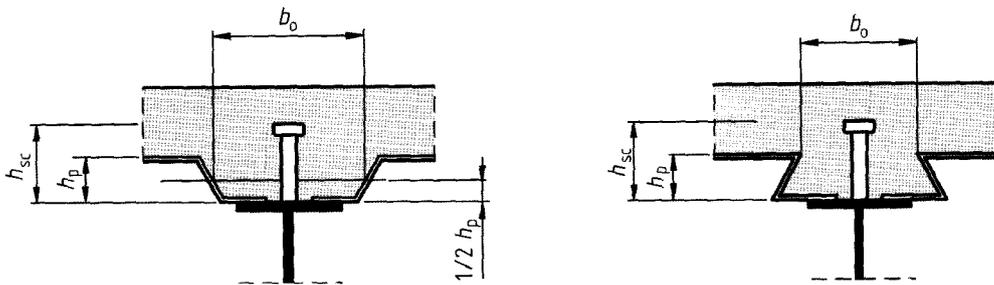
Träger mit parallel zur Trägerachse verlaufenden Profilblechen
